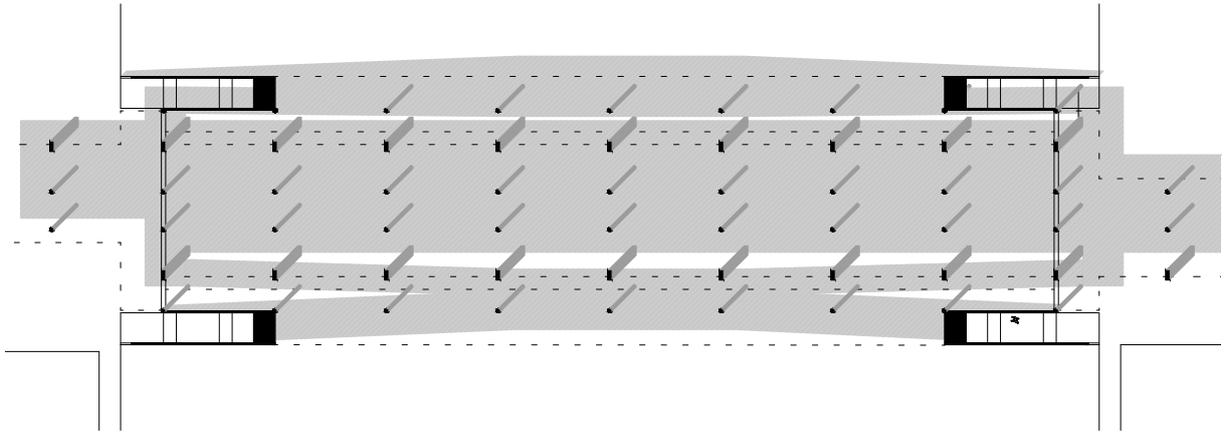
Planta nível térreo, redução da escala 1/200. Elaborada pelo autor.
